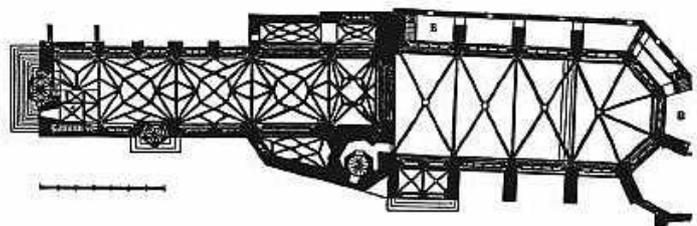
Wien, Maria am Gestade, Grundriss, 1396
